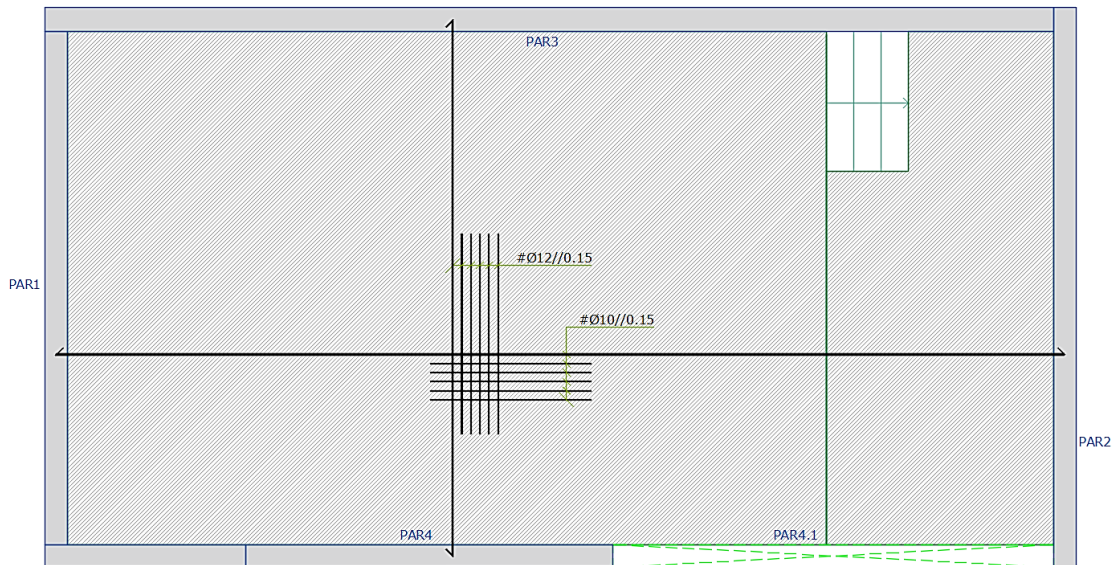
Planta malha de armaduras inferiores em X e em Y
